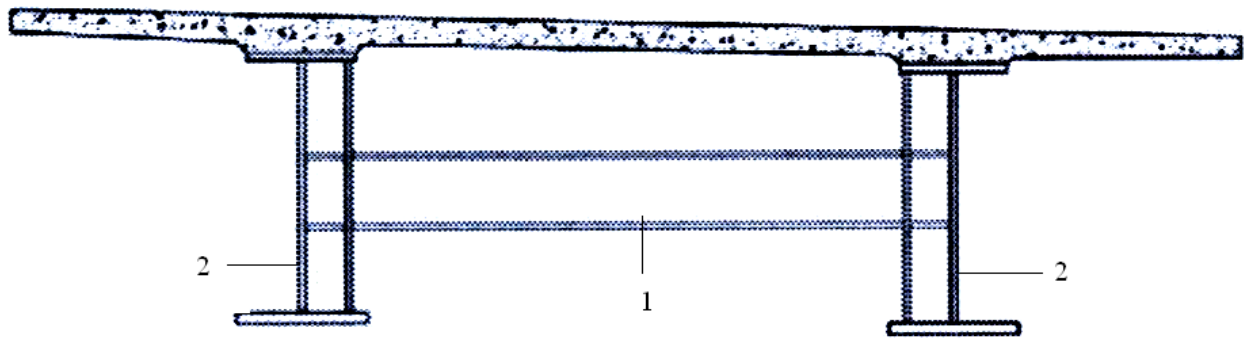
Узел опирания пролетной неразрезной балки на промежуточной опоре с присоединенной на сварке поперечной связевой балкой [23]
